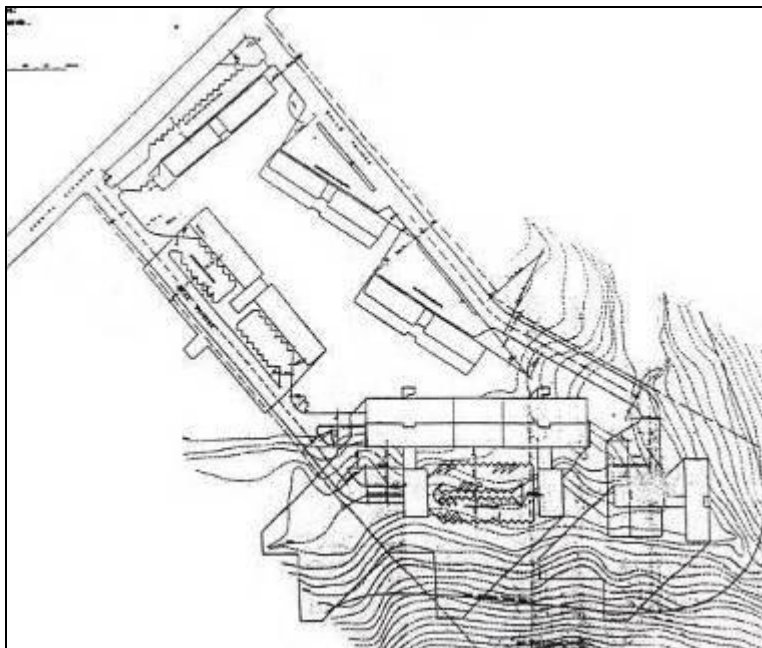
b. UR El Paraíso. Plano de Conjunto. 1er Proyecto (1952)
